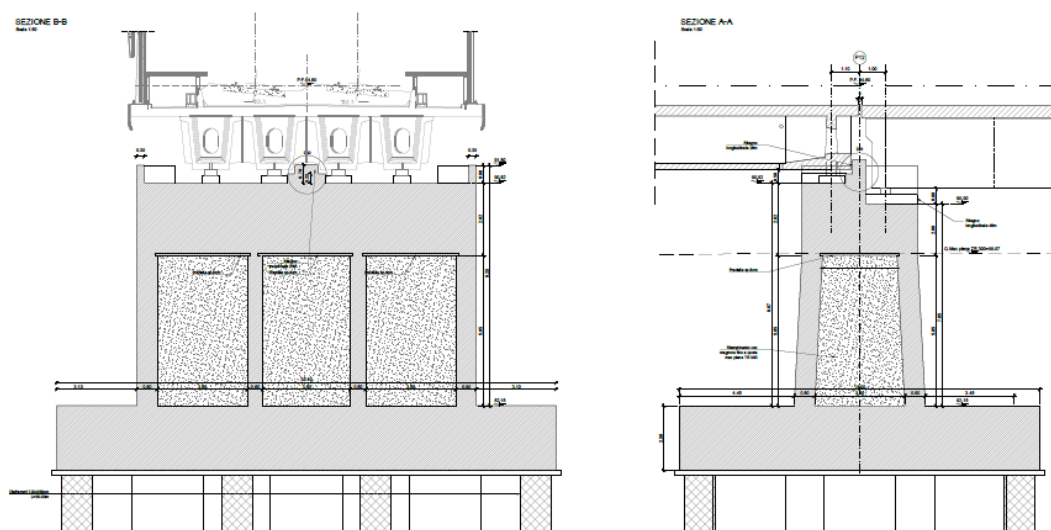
Sezione in direzione trasversale e longitudinale rispetto all'asse del viadotto P12
